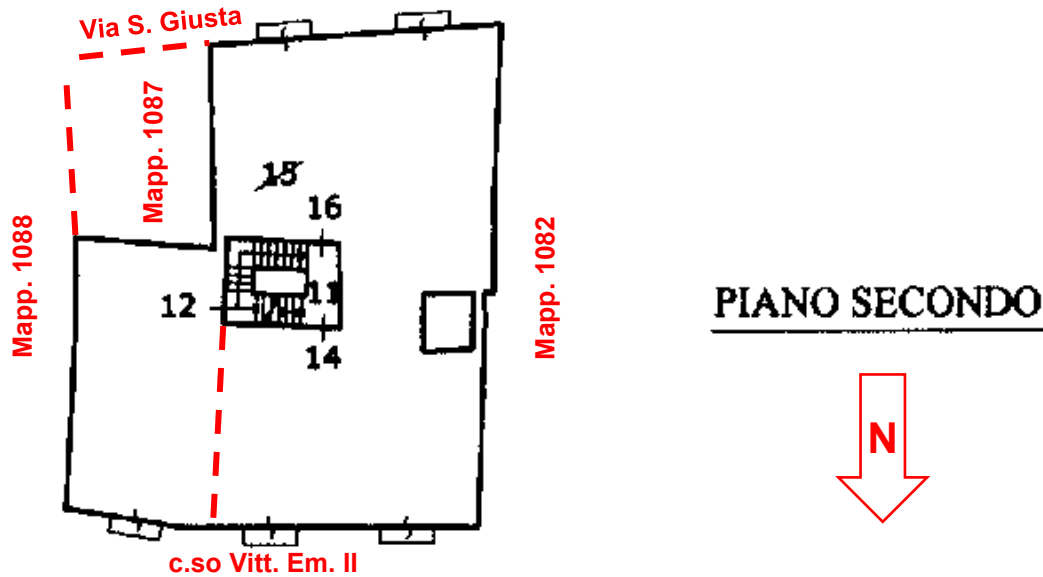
LOTTO 2. Stralcio elaborato planimetrico (fuori scala). Nord in basso
